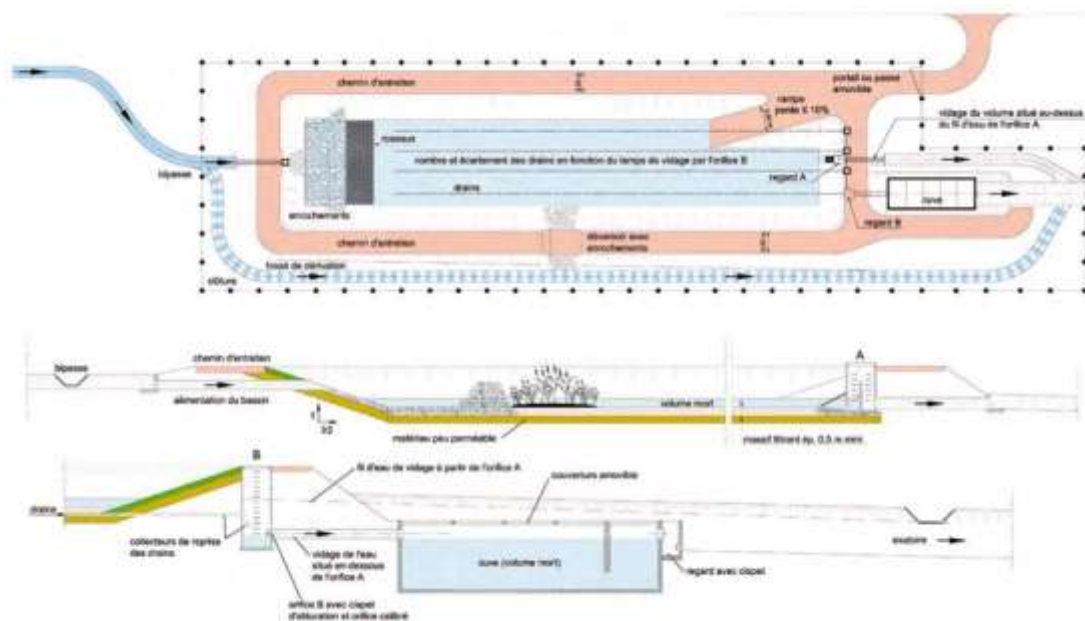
SCHEMA DE PRINCIPE D'UN BASSIN SANITAIRE
